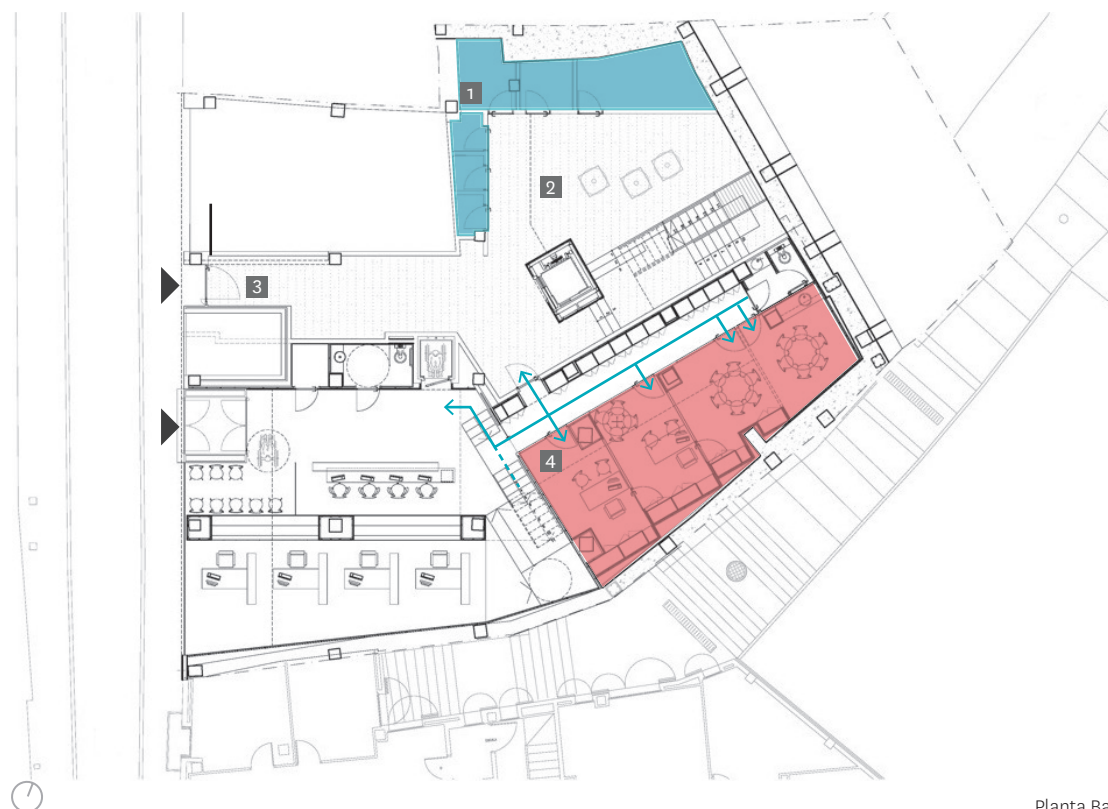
Planta baja, análisis indicador espacios comunitarios
